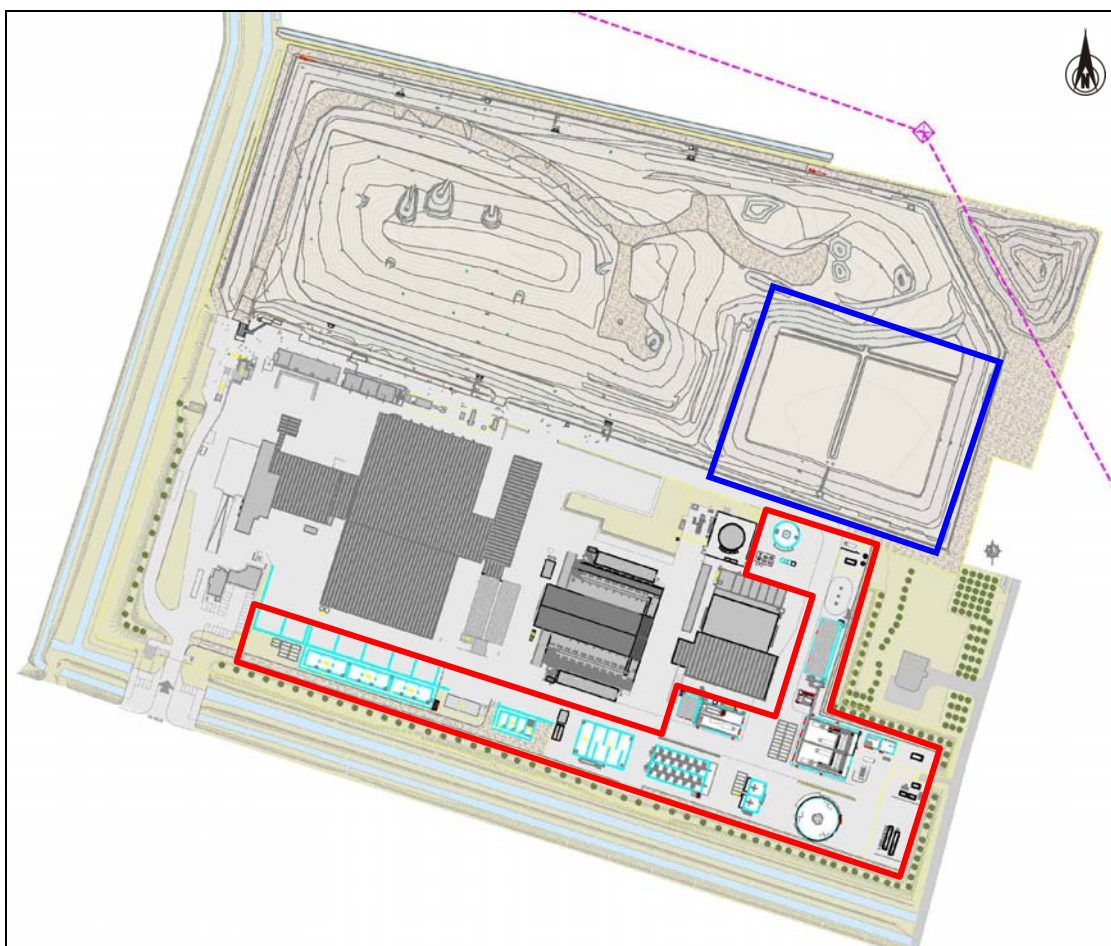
Planimetria con indicazione dell'ubicazione dell'area concernente l'intervento in progetto (area di colore rosso) e la zona prevista per il riutilizzo di parte delle terre e rocce da scavo (area di colore blu).
